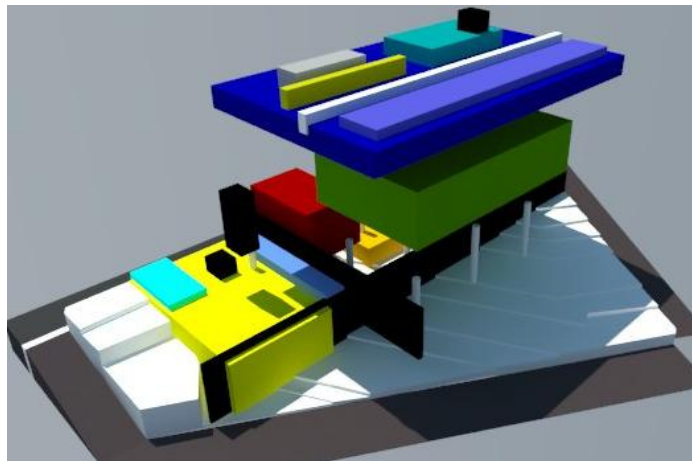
Plan masa conformación de volúmenes vista desde planta alta.
